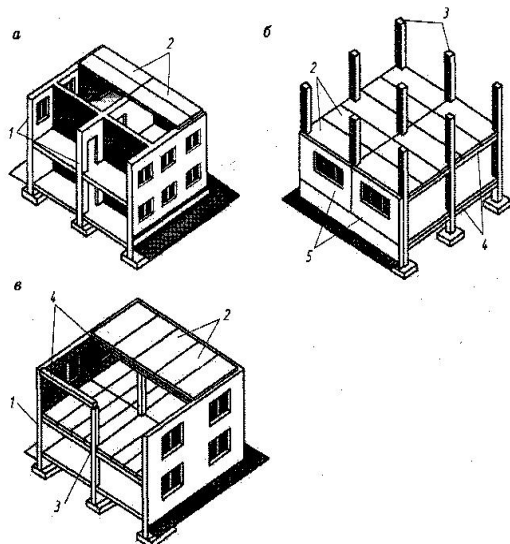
Конструктивные типы гражданских зданий: а — бескаркасный; б — каркасный; в — с неполным каркасом; 1 — несущие стены; 2 — междуэтажные перекрытия; 3 — колонны; 4 — ригели; 5 — самонесущие стены
